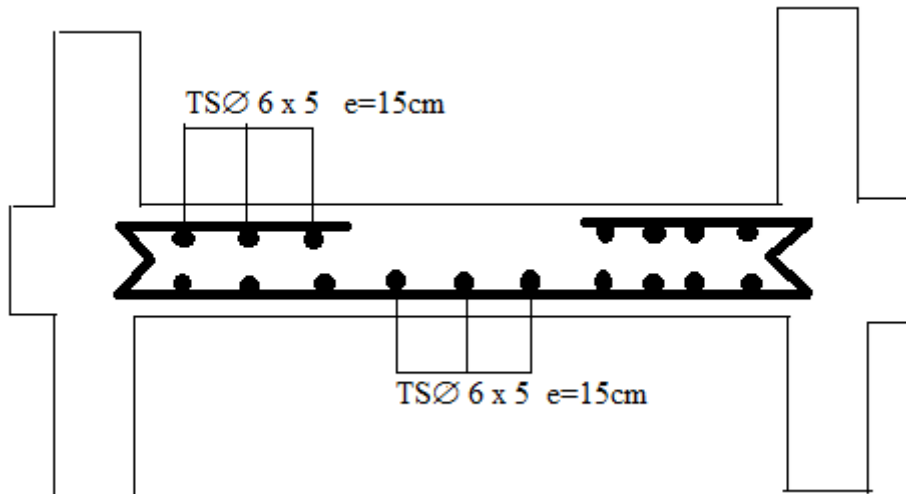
Schéma du ferrillage de la dalle plancher terrasse.
